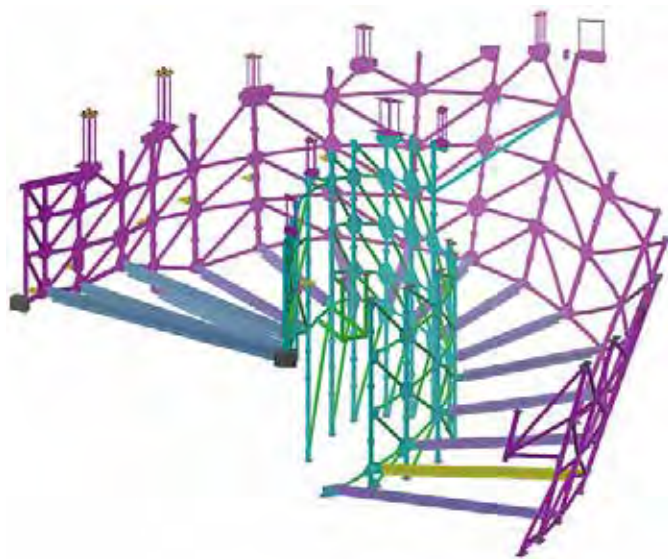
Stahlkonstruktion der großen Foyertreppe (HASLINGER Stahlbau GmbH)
